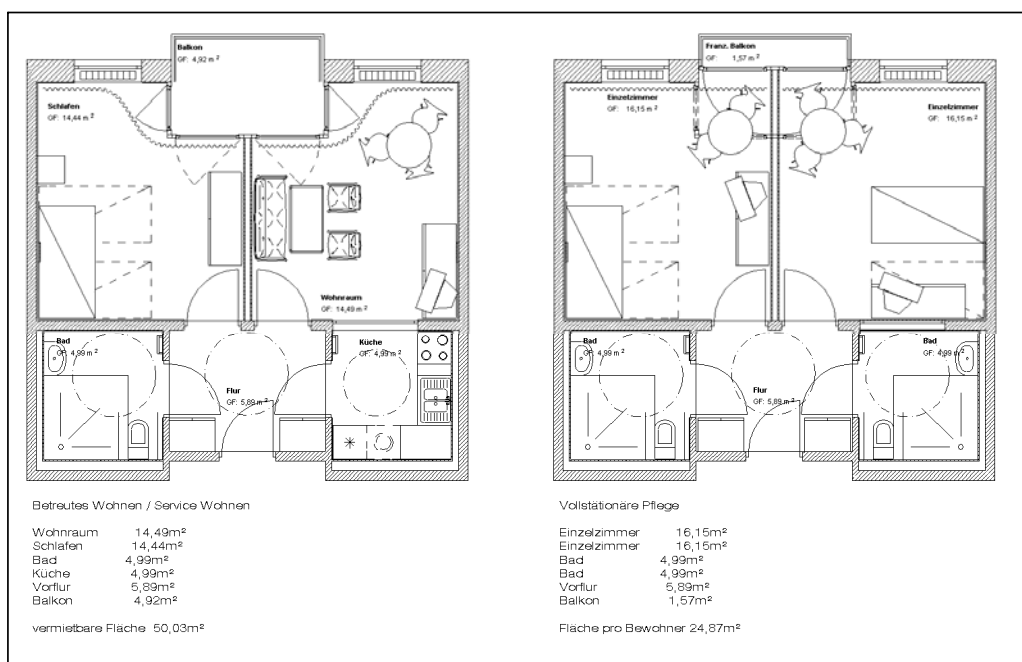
Flexibler Grundriß (empirica, Krings-Heckemeier, Fachvortrag Messe Stuttgart am 17.3.2004)
